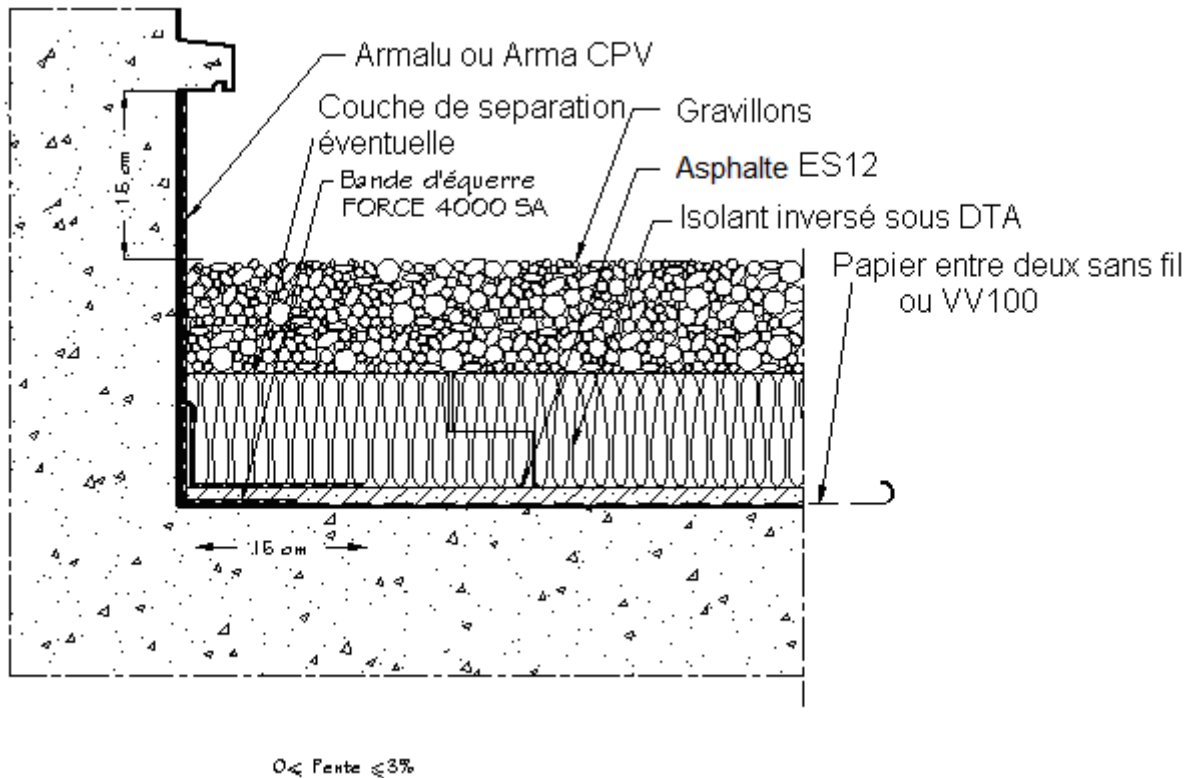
Relevés / Coupe type avec équerre de renfort sous l'asphalte – Terrasse inaccessible, protection par gravillons
